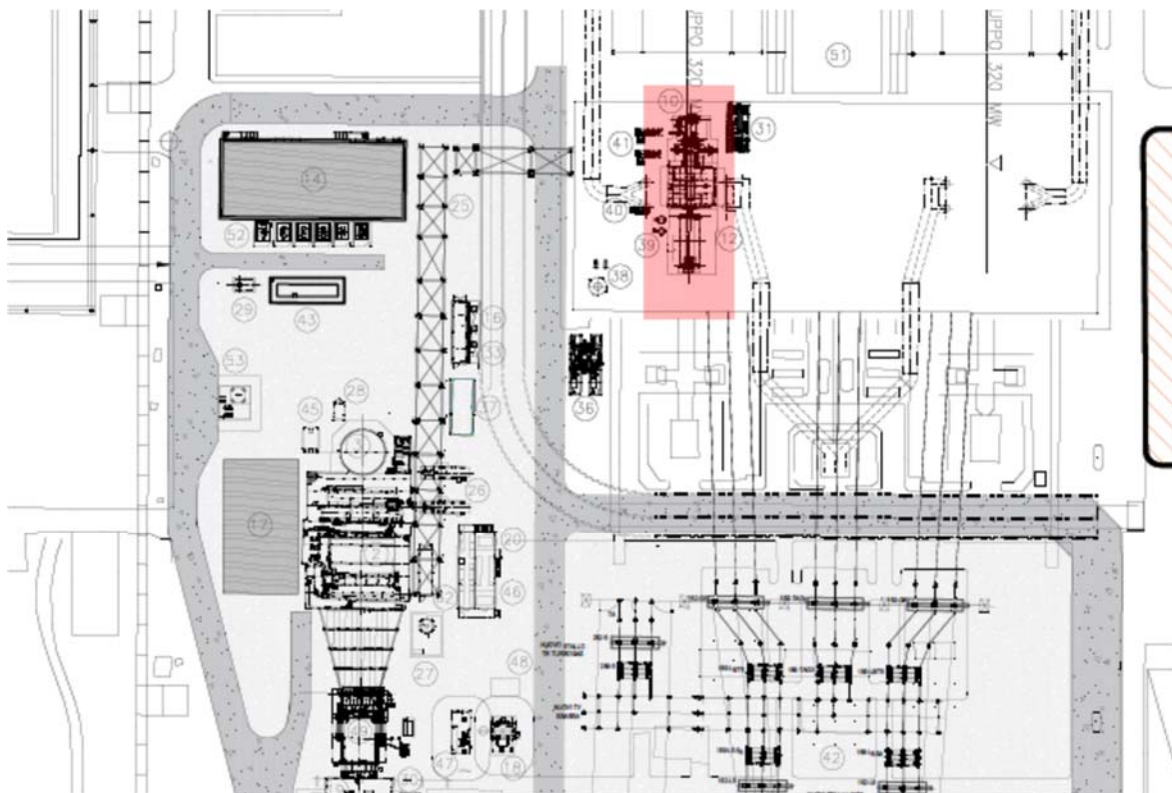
Planimetria d’impianto – Ubicazione turbina a vapore
